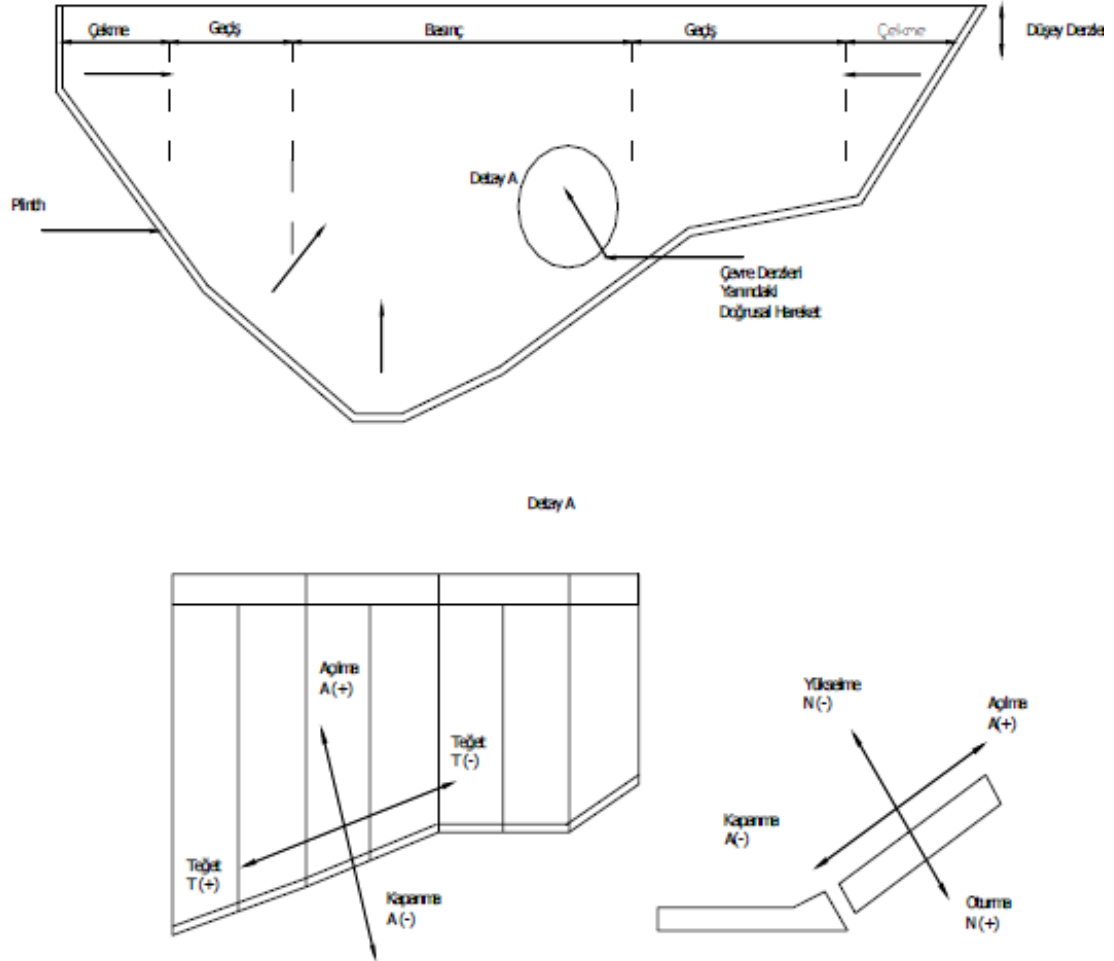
Beton Dolgu Üzerindeki Topuk Plak Detayı (Tosun vd., 2007)
